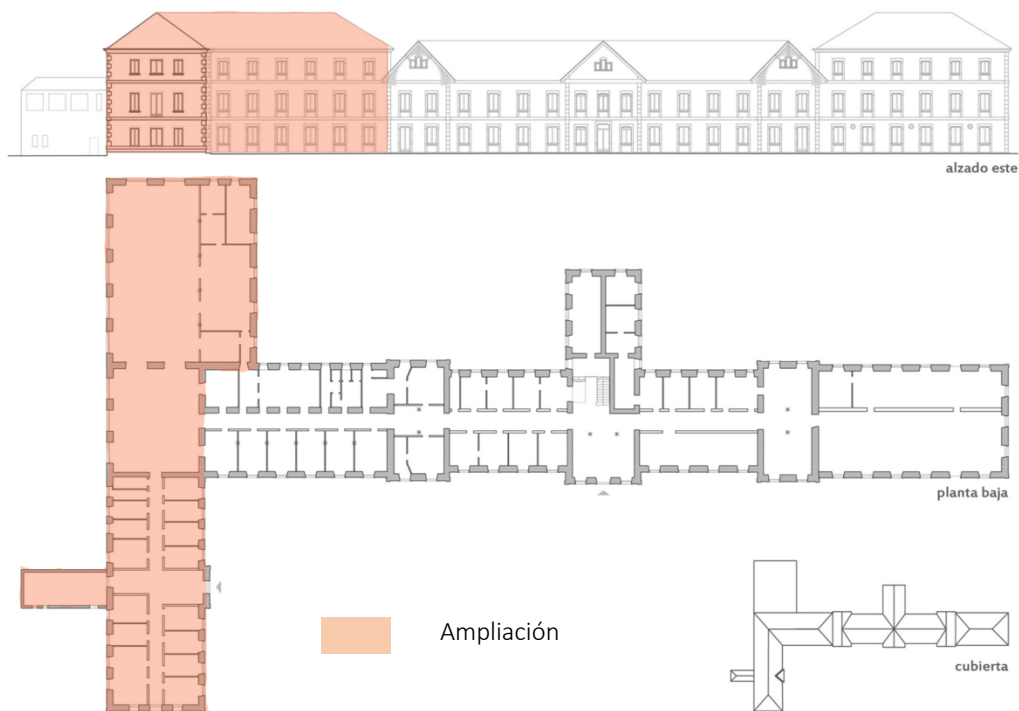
Alzado frontal y planta con la segunda ampliación
